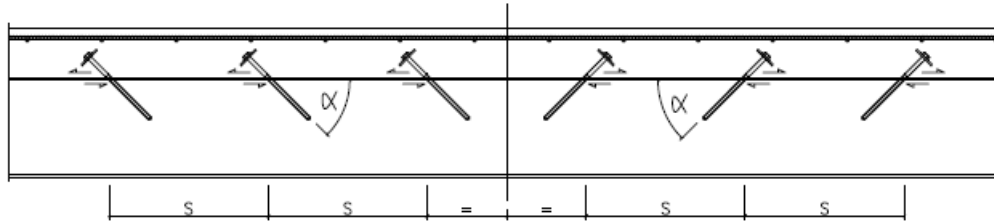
Vista de perfil en la que los conectores se colocan con una inclinación  $\alpha$  a lo largo del plano de simetría de la viga.
